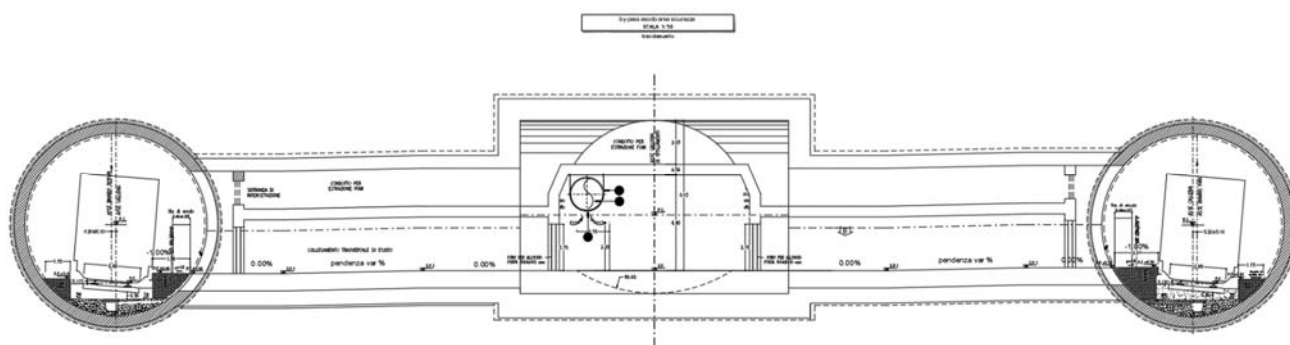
Vista in sezione – Intersezione finestra F1 con i bypass d'esodo
